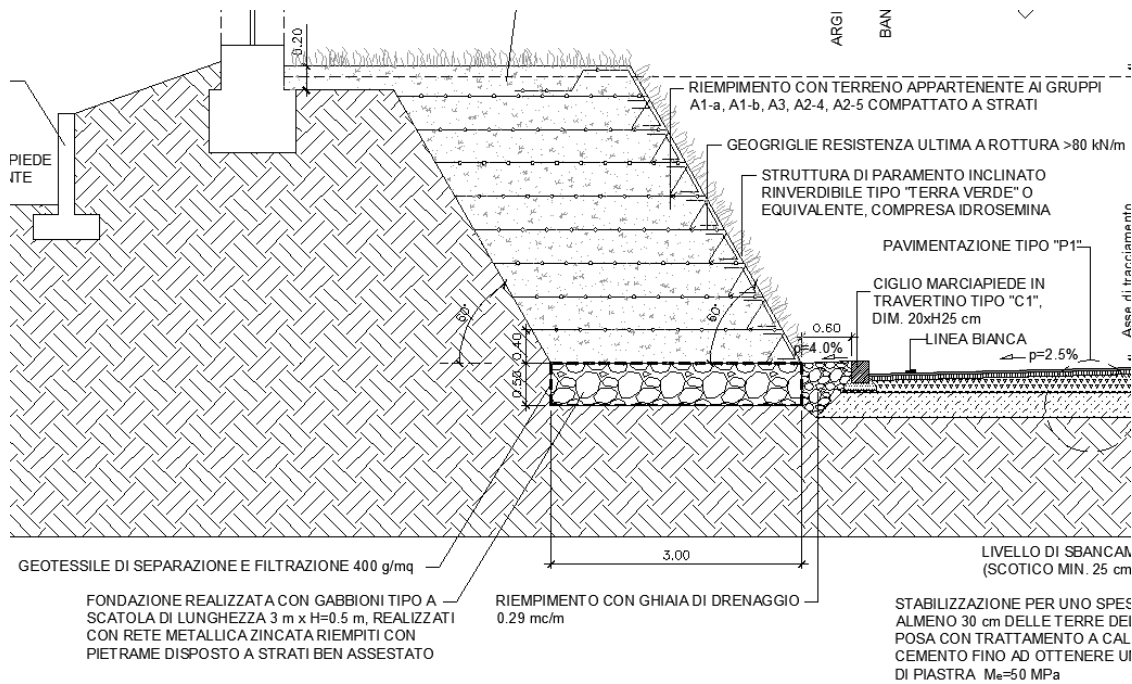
Dettaglio arginello drenante al piede del tratto nord in terra rinforzata rinverditata
